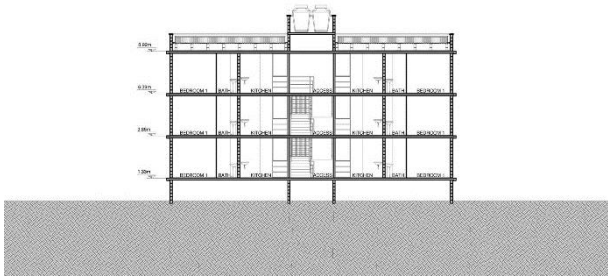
Urb. Jardim Vicentina – Sección longitudinal y planta tipo de una de las tres tipologías de bloque
